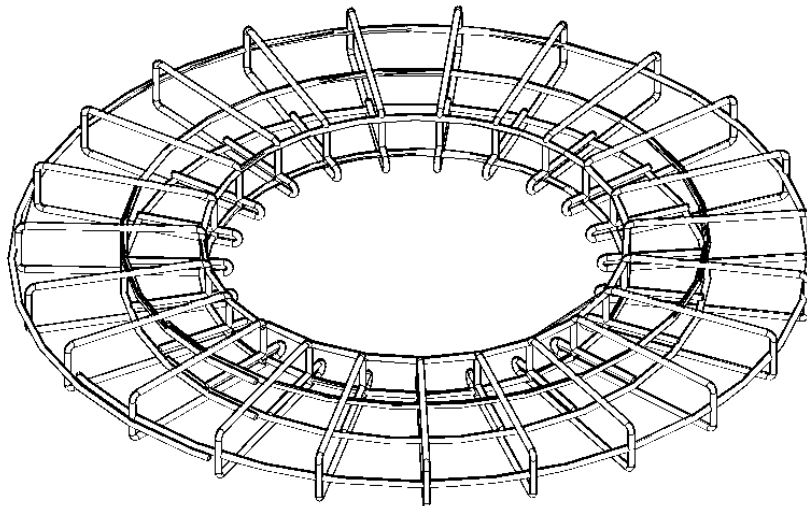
Refuerzo de Placa Superior del Pozo de Inspección
